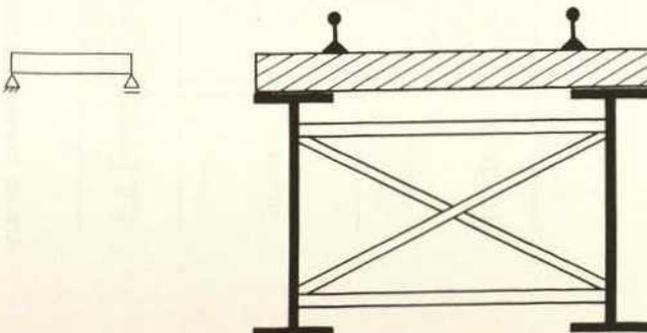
Schematische Darstellung einer Eisenbahnbrücke des Fachwerkträger-Typs 3.2 (Seitenansicht).
